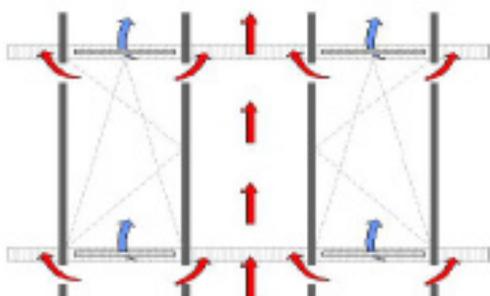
BÂTIMENT AVEC FAÇADE VENTILÉE
